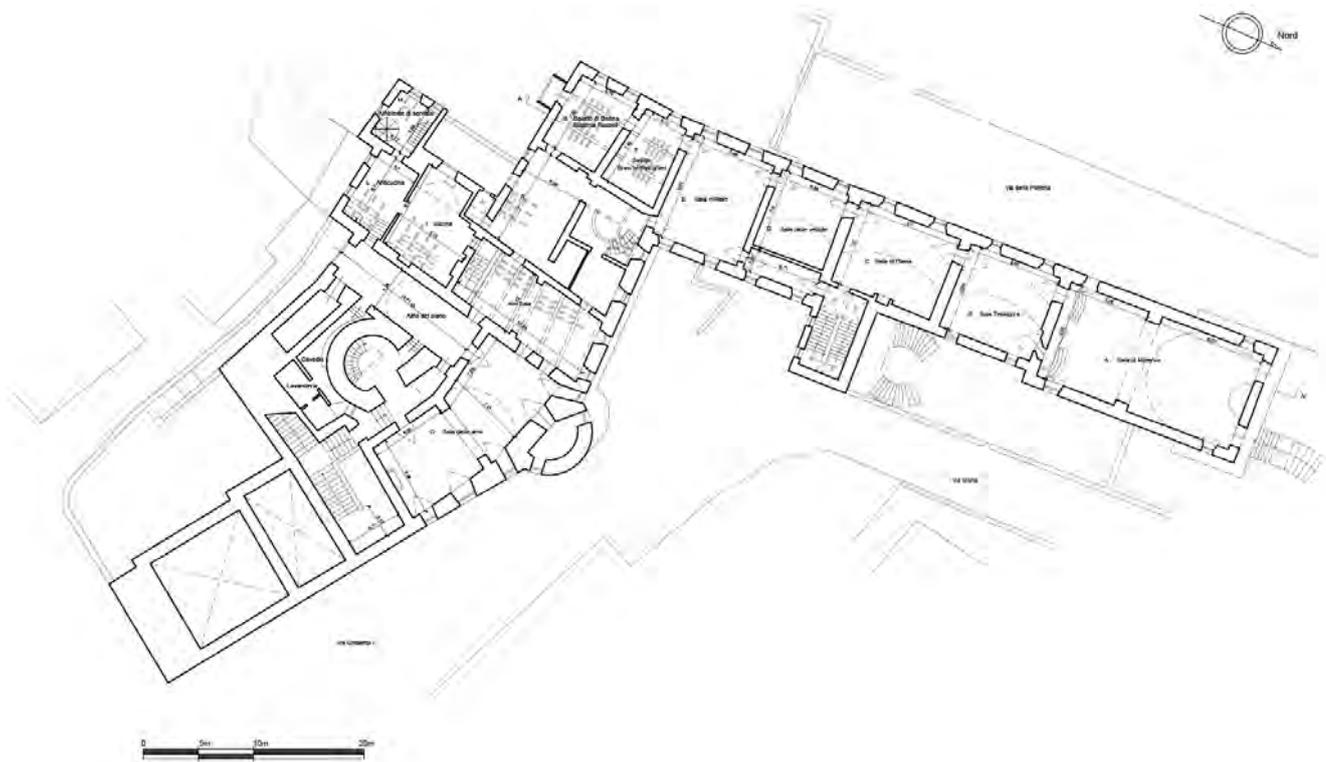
Pianta del piano primo (restituzione grafica D. Calzolaio, 2019).
